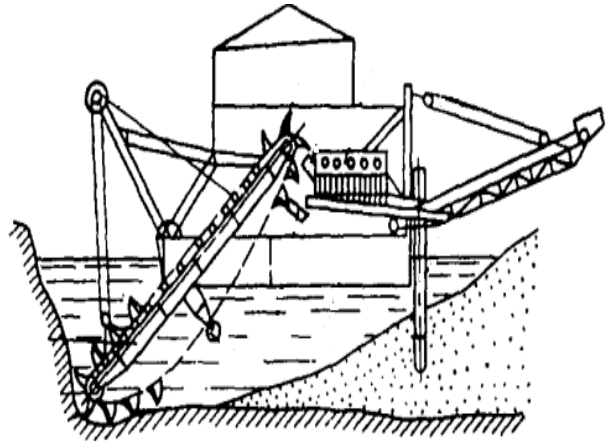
Плаваюча землевсмоктуюча установка з багаточерпаковим пристроєм
